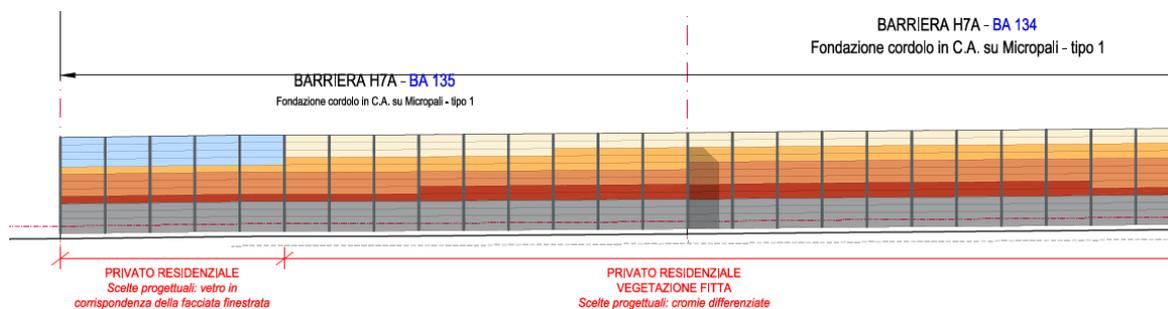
Sviluppo del prospetto delle barriere BA 135 e BA 134 su BD
